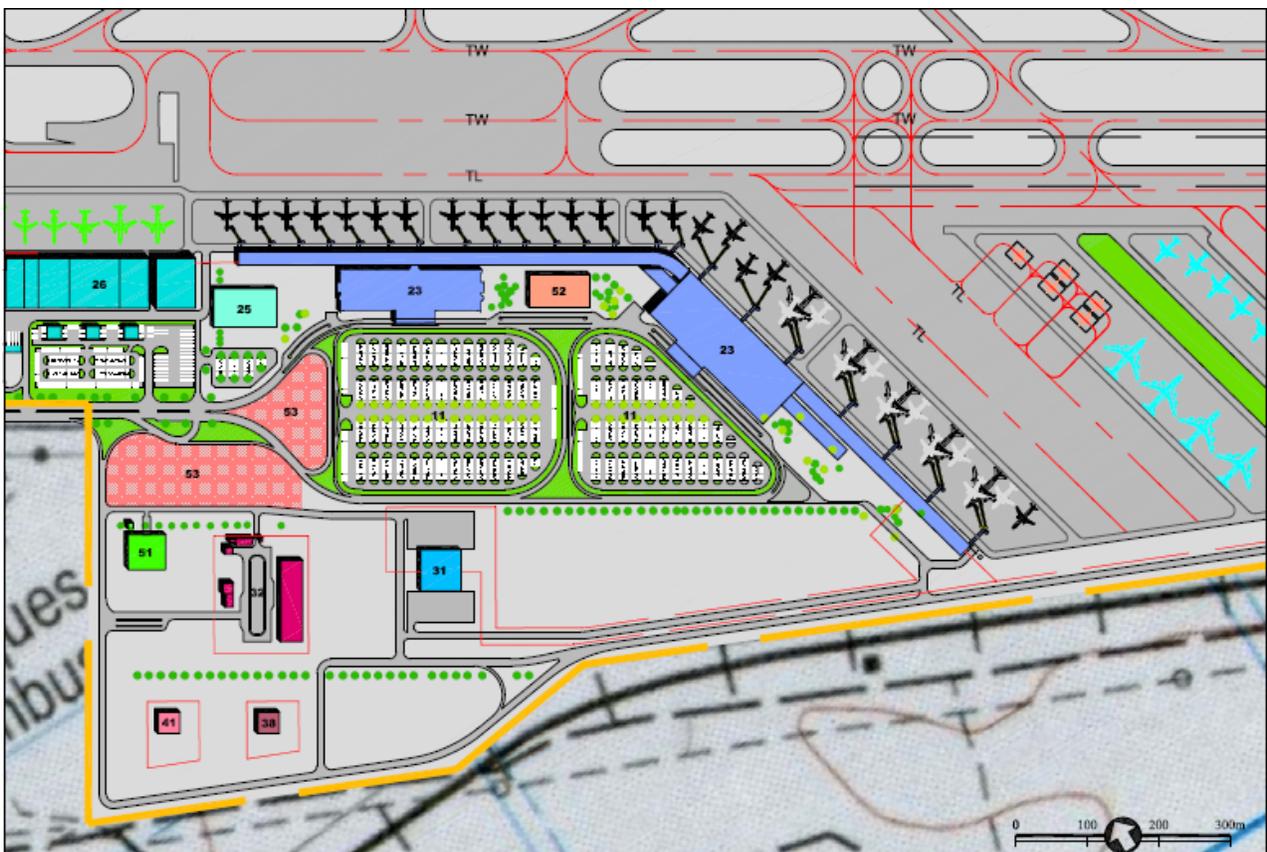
Edificio terminal proyectado en el Plan Maestro actual.
